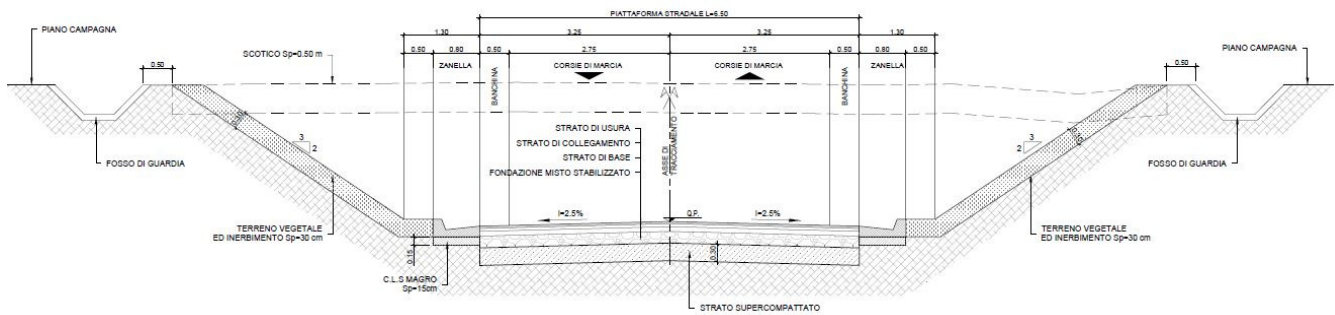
Dest. Particolare 6.5m - sezione tipo in trincea
